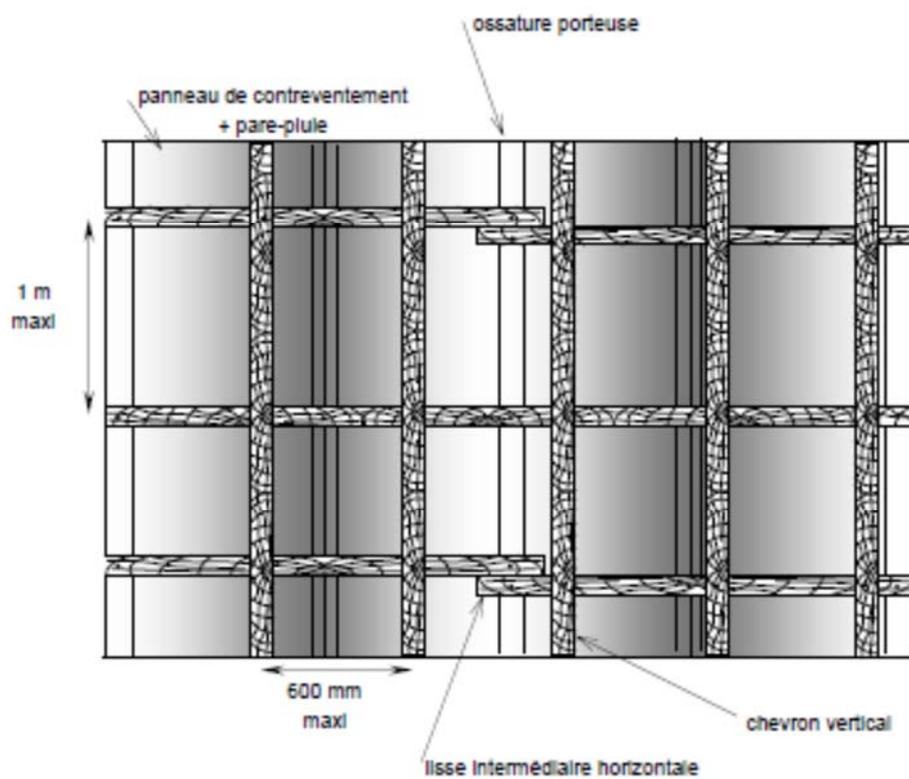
Raccordement de lisses horizontales - Pose sur COB
